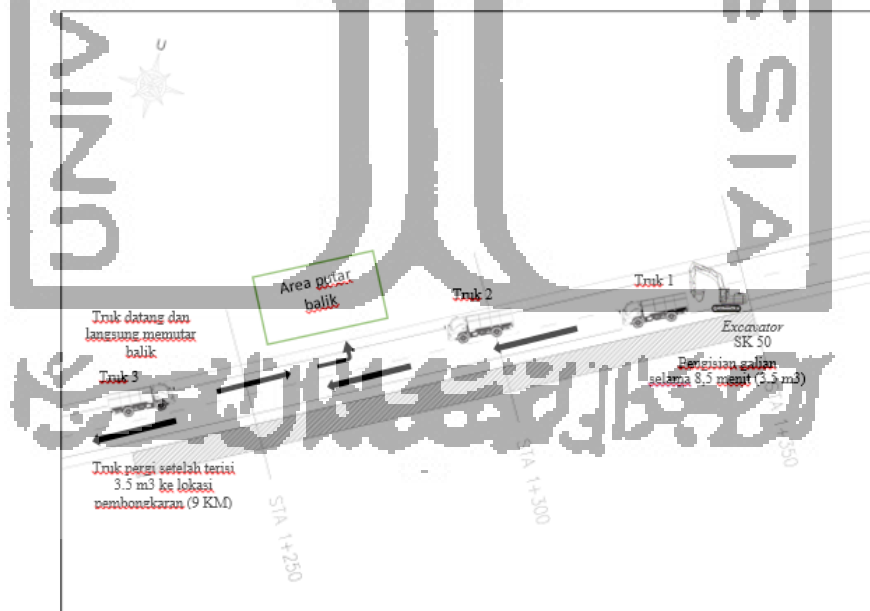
Layout untuk Excavator SK200 dengan 3 unit dump truck
